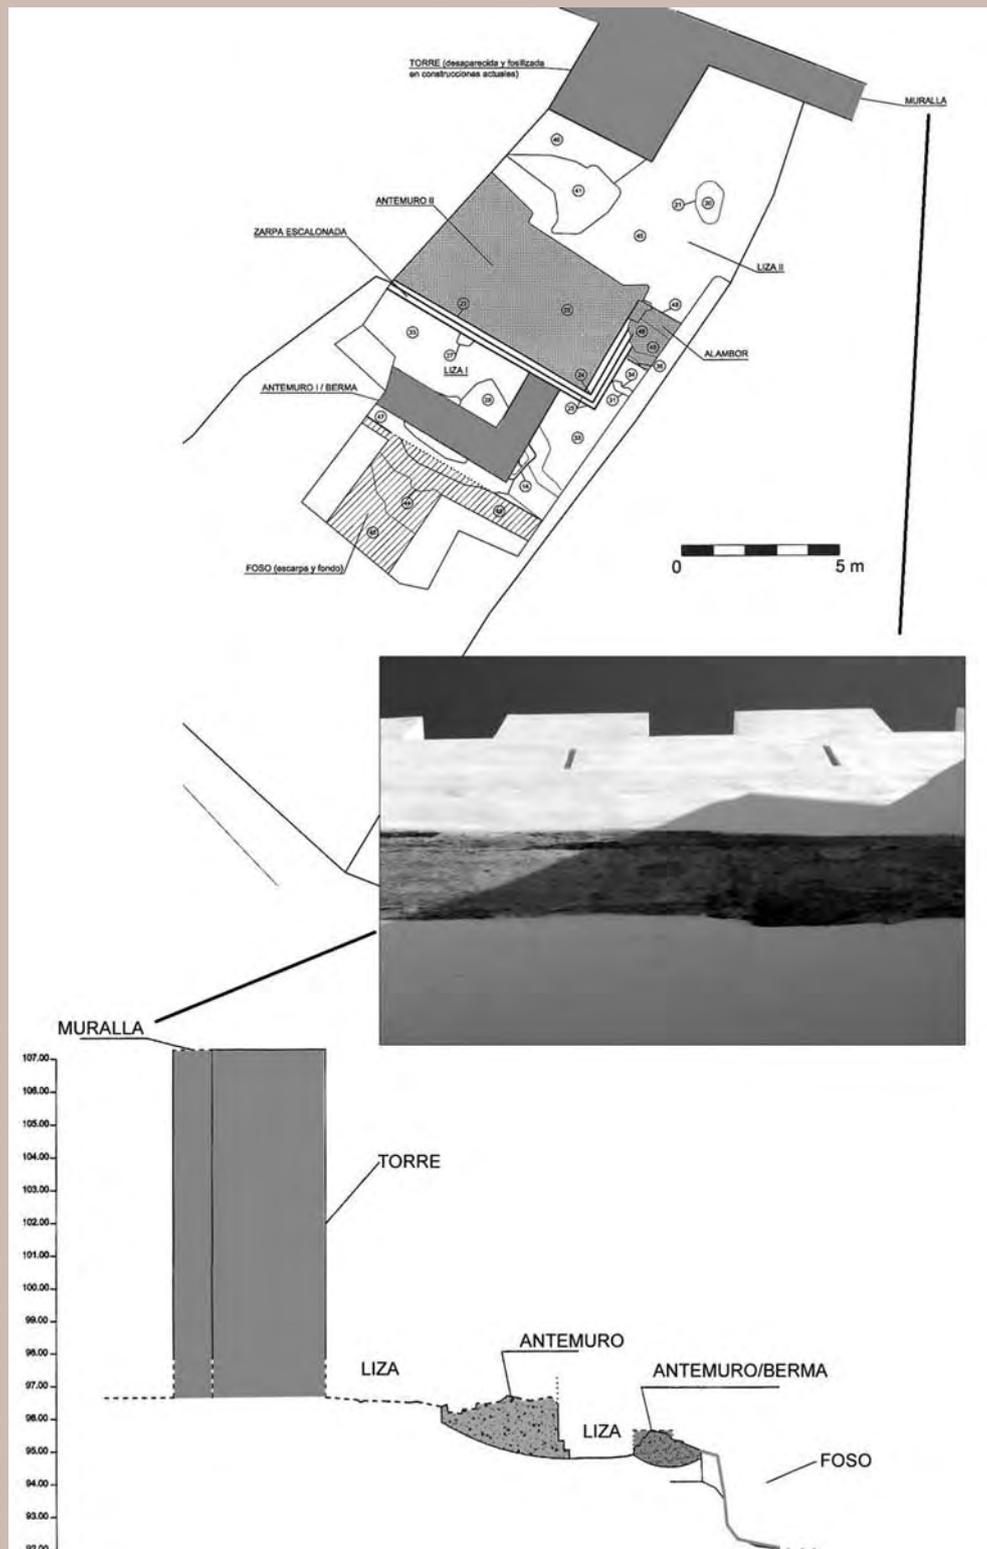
Plano y sección de las murallas de madīnat Bāguh de época califal, almohade y nazarí, documentadas en el lado Oeste de la Puerta de Santa Ana.
